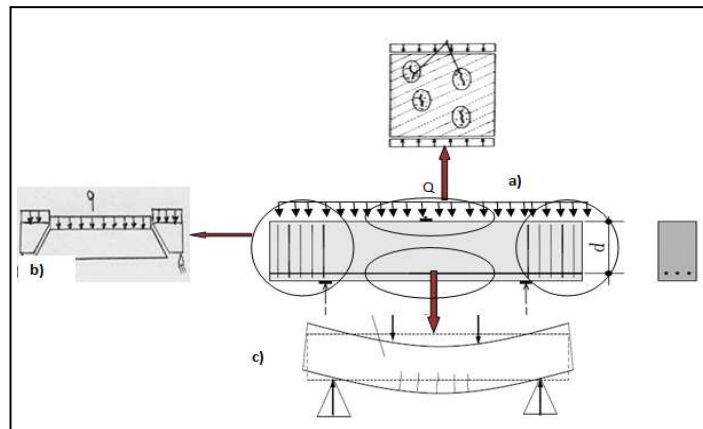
Modes de fissures dans une poutre en béton armé [9] .
